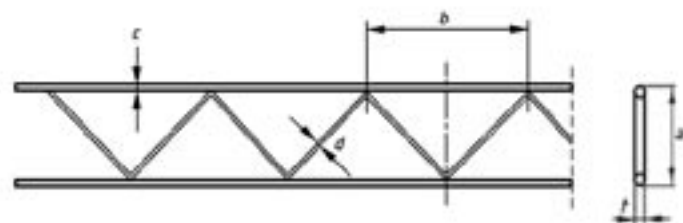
MURFOR® – příhradový typ (truss type)
